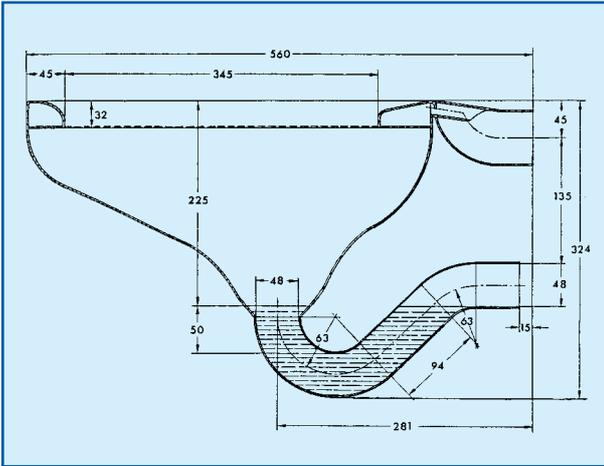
Schnitt durch ein wandhängendes Tiefspülklosett aus Edelstahl mit „Wassersparendem Rohrgeruchverschluss“ DN 50 ($d_i = 48 \text{ mm}$); DPÚa AZ 195 11 127.3-25
